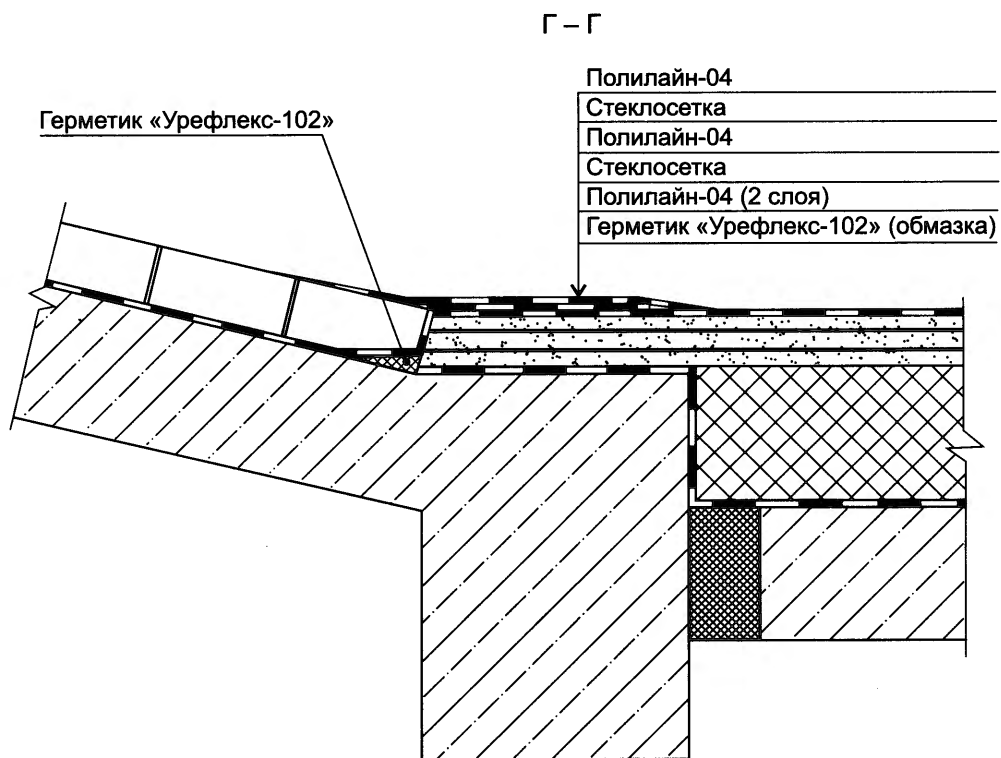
Гидроизоляция узла примыкания спуска к полу
